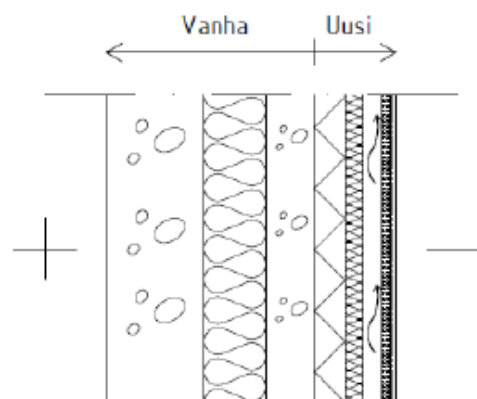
Lisäeristetty betonisandwichelementti. Eristerappaus
